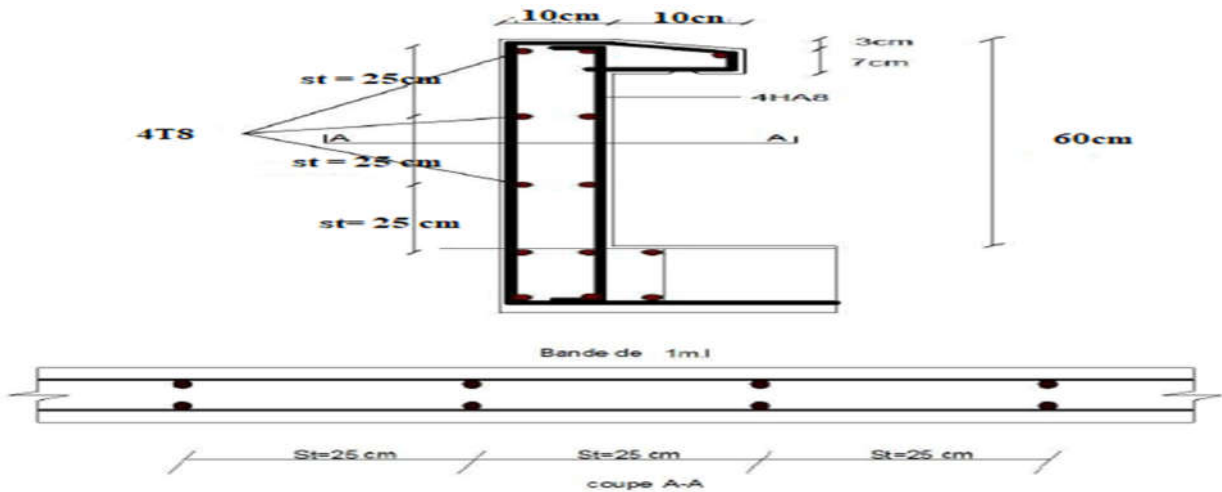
SCHEMAS DE FERRAILAGE D'ACROTERE
